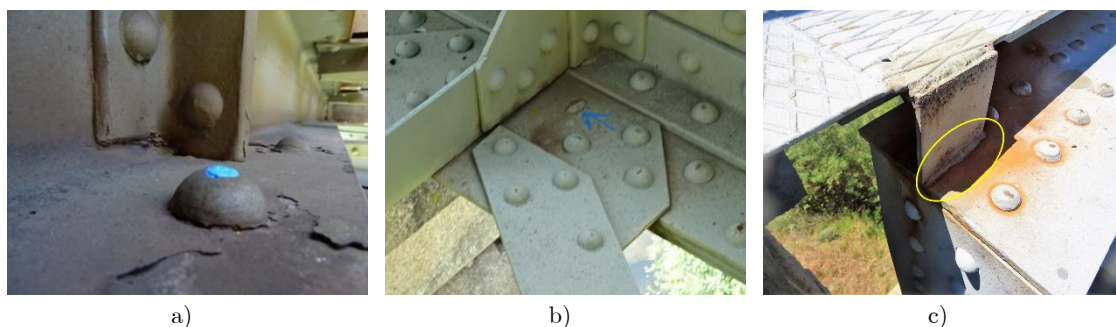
Anomalias registadas em ligações rebitadas e soldadas: a) Rebite “leve”, b) Falta de cabeça de rebite e c) Fissuração em ligações soldadas.
